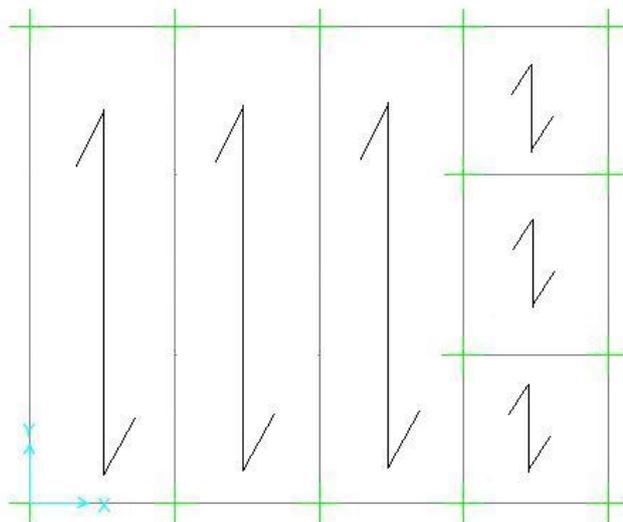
Disposición de las losas alveolares pretensadas. SAP2000
